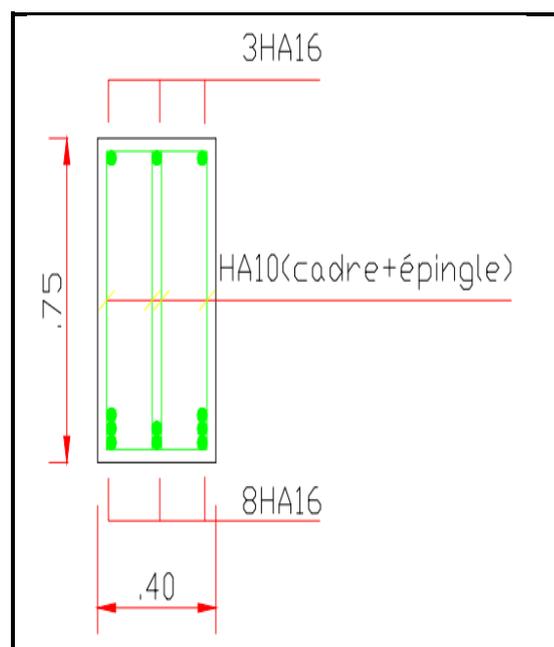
ferrailage coupe en appuis selon x-x et y-y.
